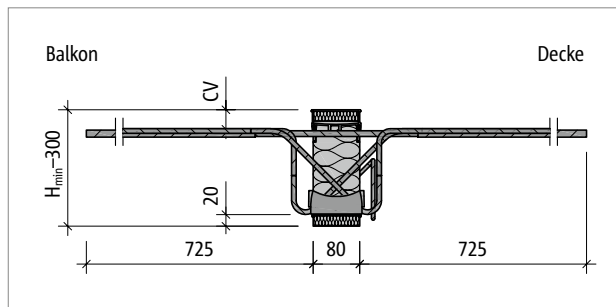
Schöck Isokorb® T Typ KL-M4-VV1: Produktschnitt
